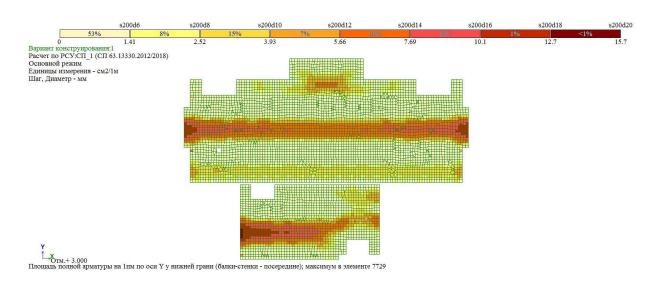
Нижняя арматура в плите перекрытия вдоль оси оси Y
